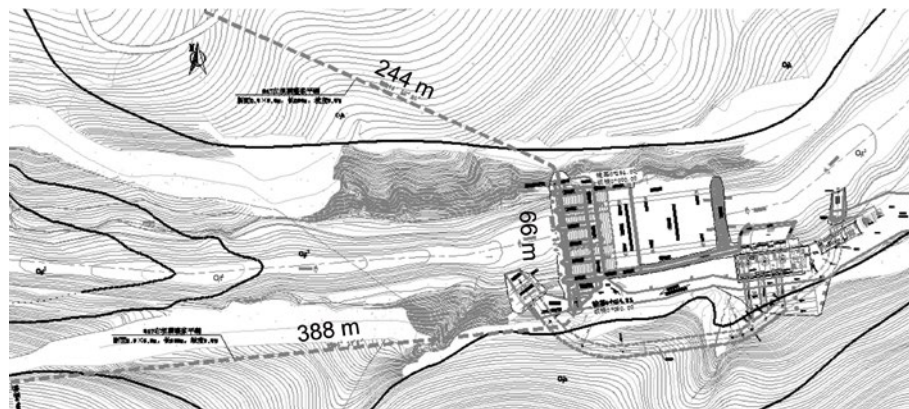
Lageplan des geplanten Dichtschleiers für die Wasserkraftanlage Shichan
